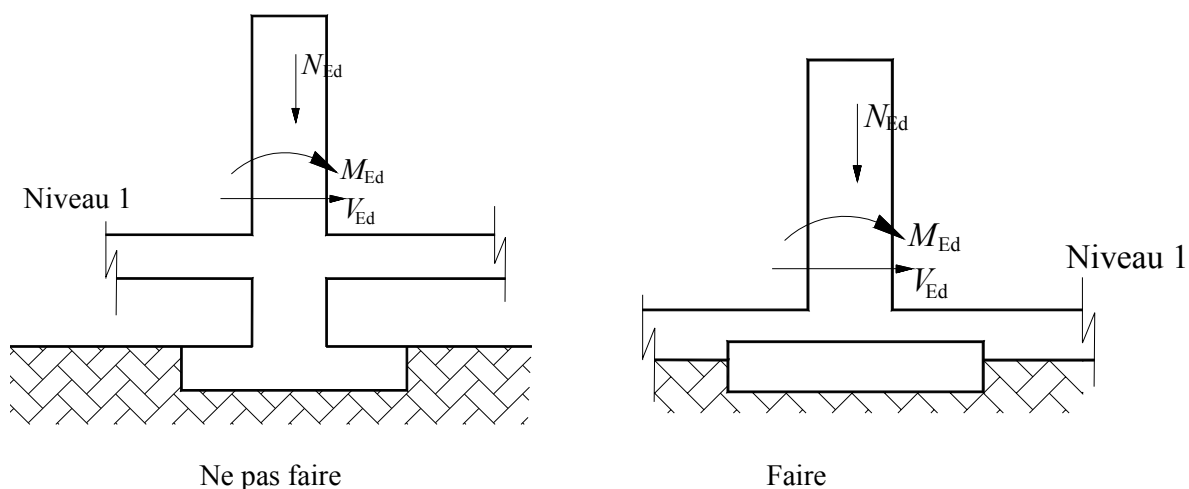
Les poteaux courts entre poutres de liaison et semelle sont à éviter.
